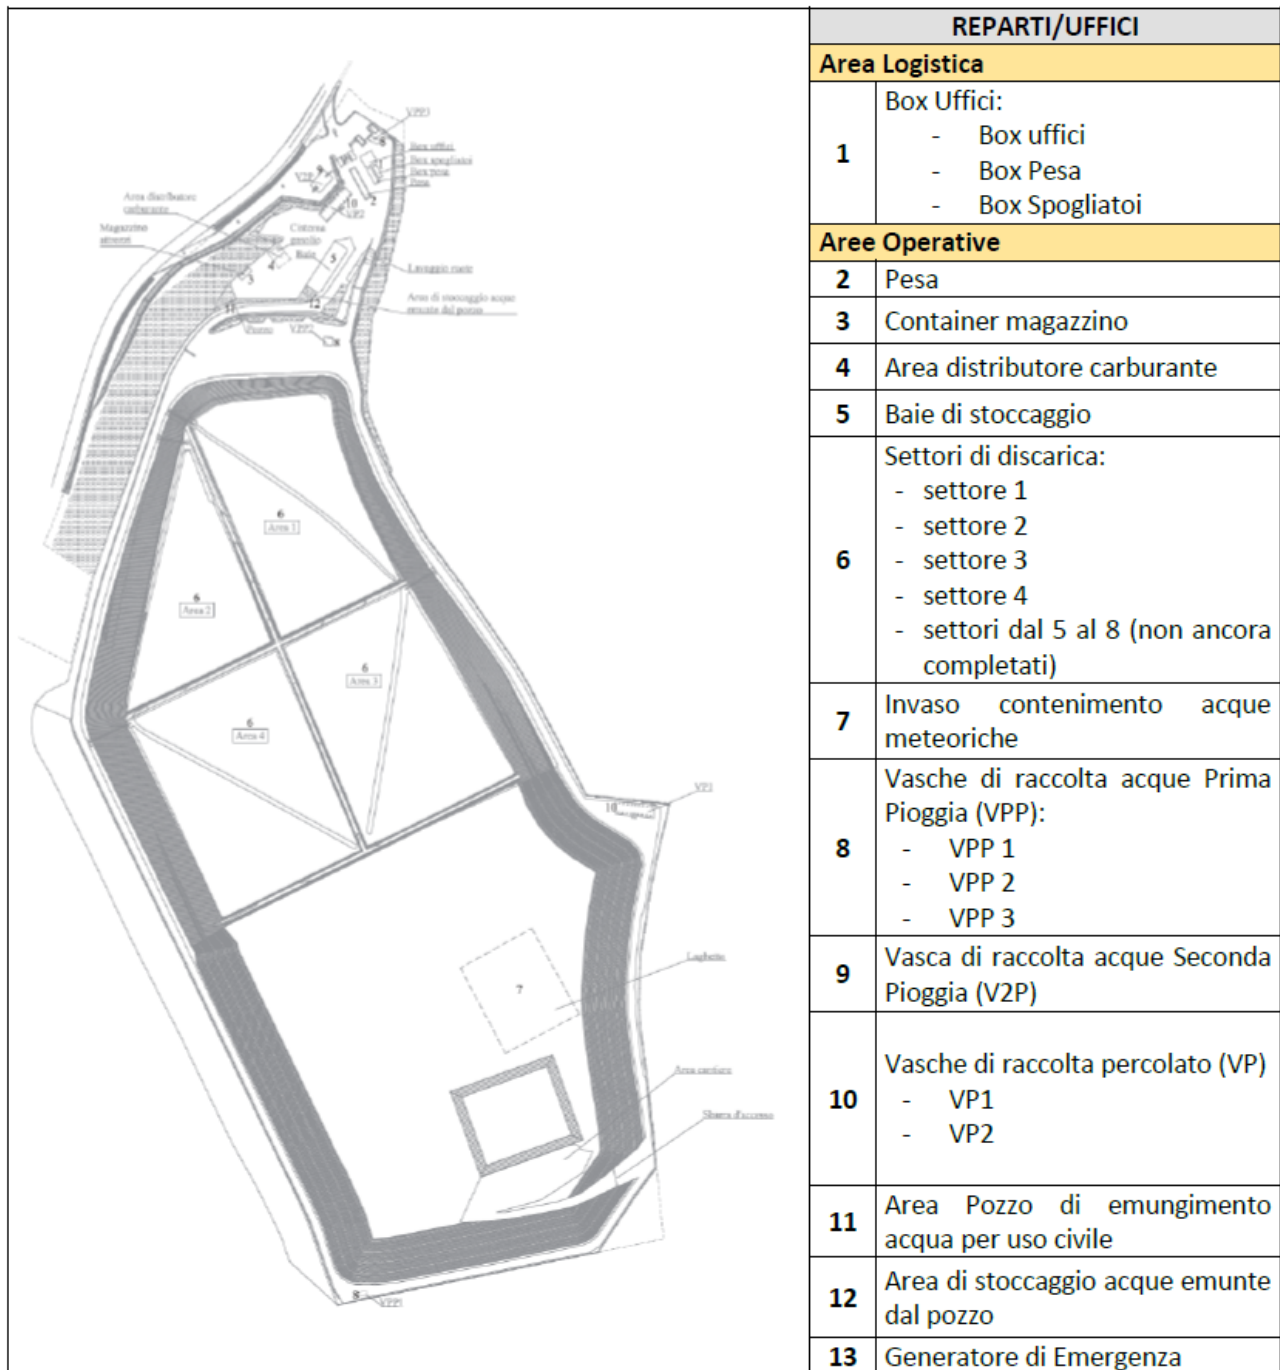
Planimetria con indicazione delle aree di cui si compone il sito discarica di Sezzadio
